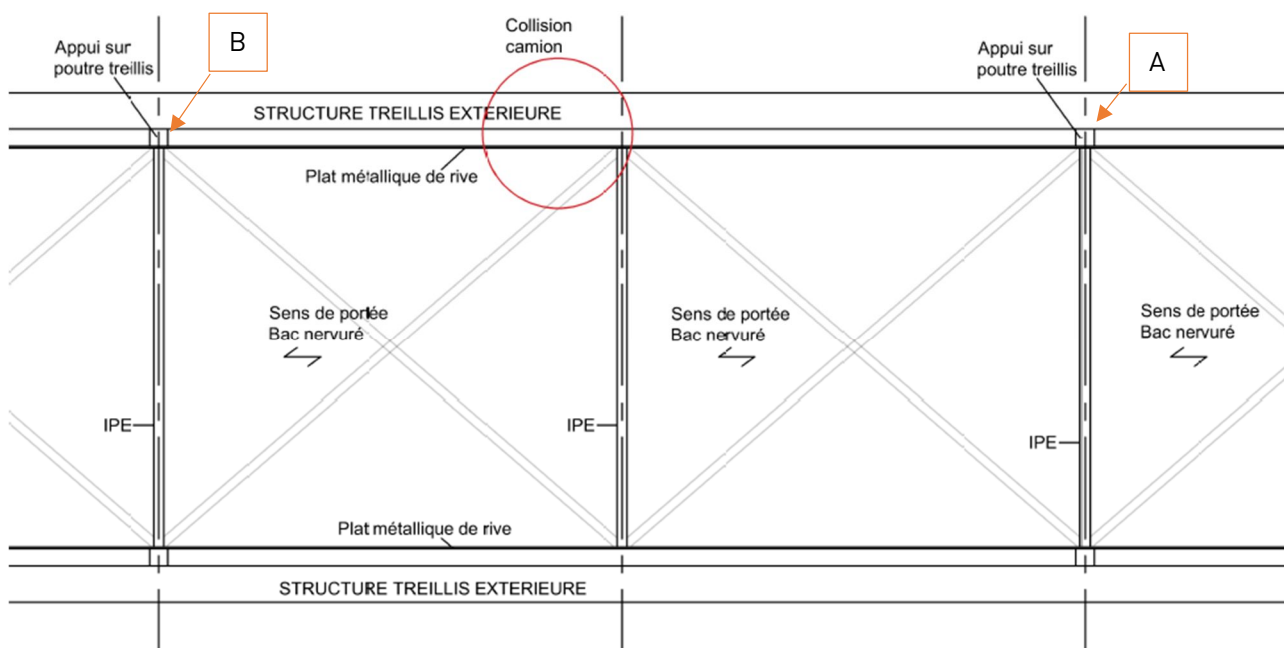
Vue en plan - plancher bas passerelle piétonne (Sans échelle)
